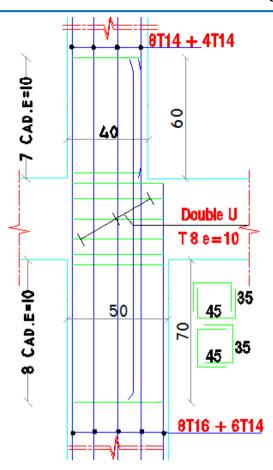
Ferraillage de recouvrement des poteaux (50×40) cm² et (40×40) cm².
